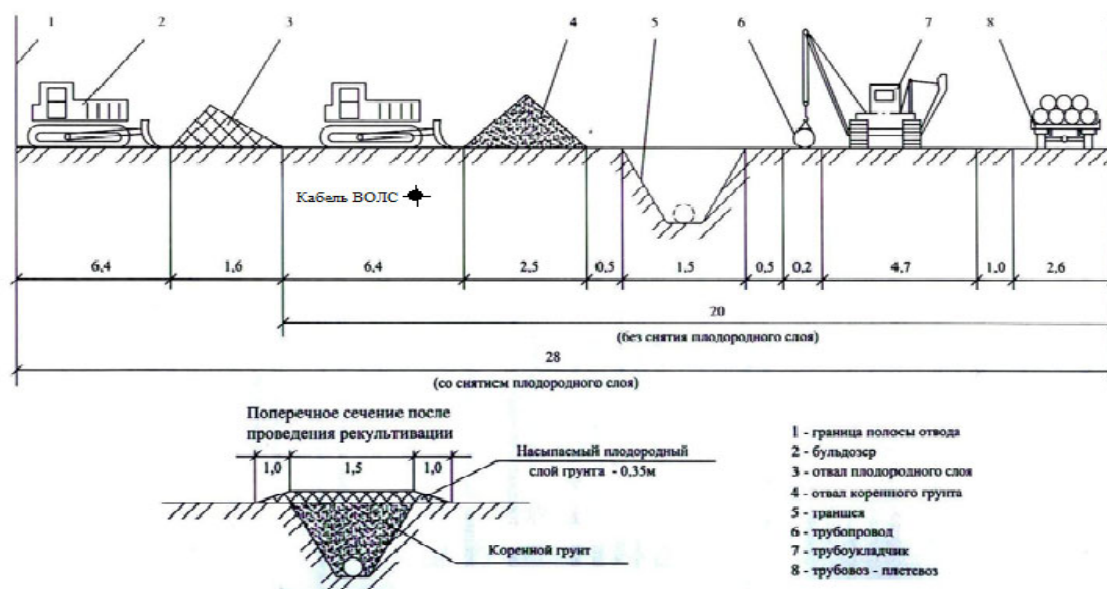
Зоны строительной полосы и схема расположения машин и отвалов грунта при строительстве газопровода.
